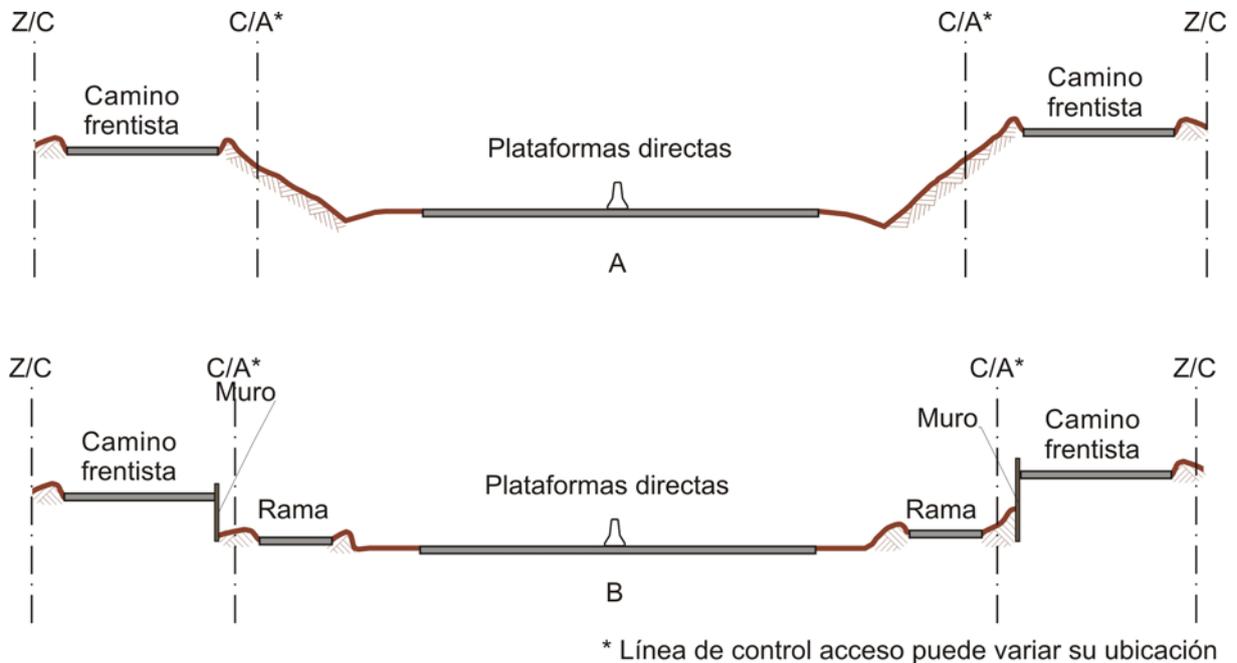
Secciones transversales restringidas para autopistas en desmonte.
